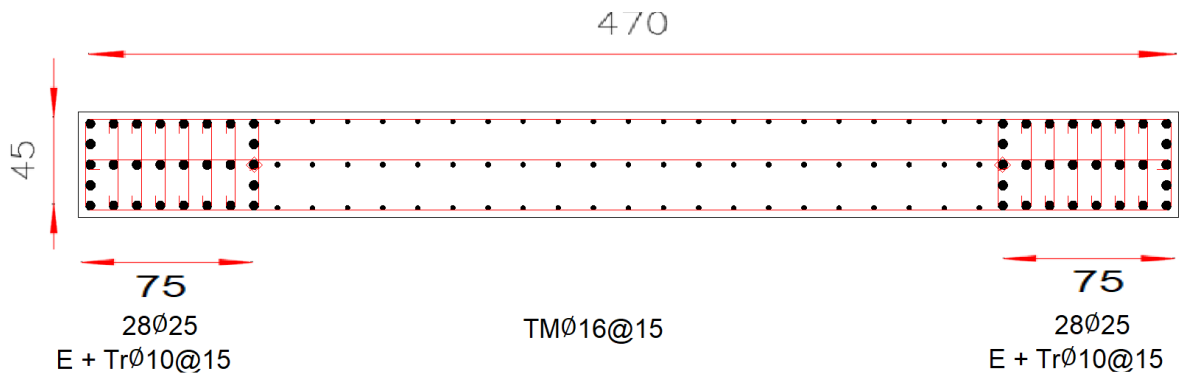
Disposición de armadura muro R modelo de 20 pisos.
